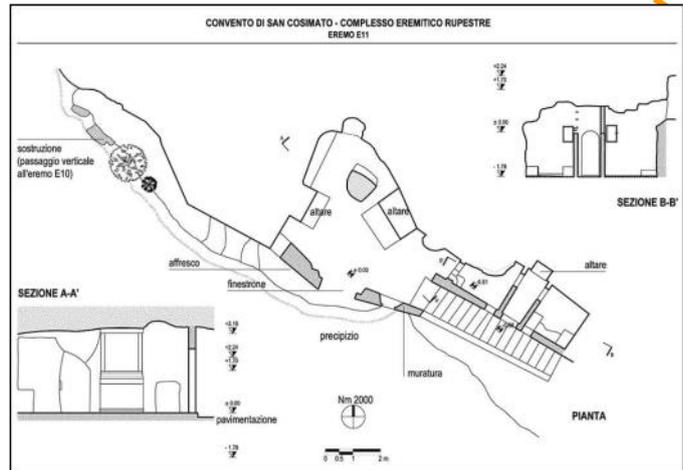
Planimetria della parte principale del complesso rupestre di San Cosimato (restituzione grafica di Roberto Basilico, Archivio F.N.C.A.).
